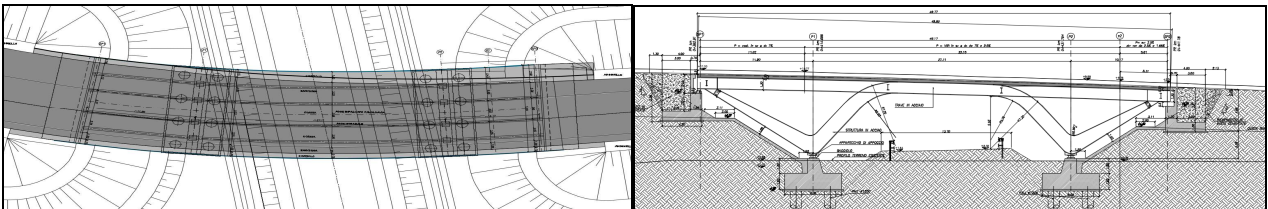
Pianta Cavalcavia e Sezione longitudinale Strada Comunale Bulgarina
